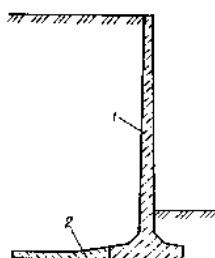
Конструкция подпорной стены с использованием универсальной стеновой панели:
